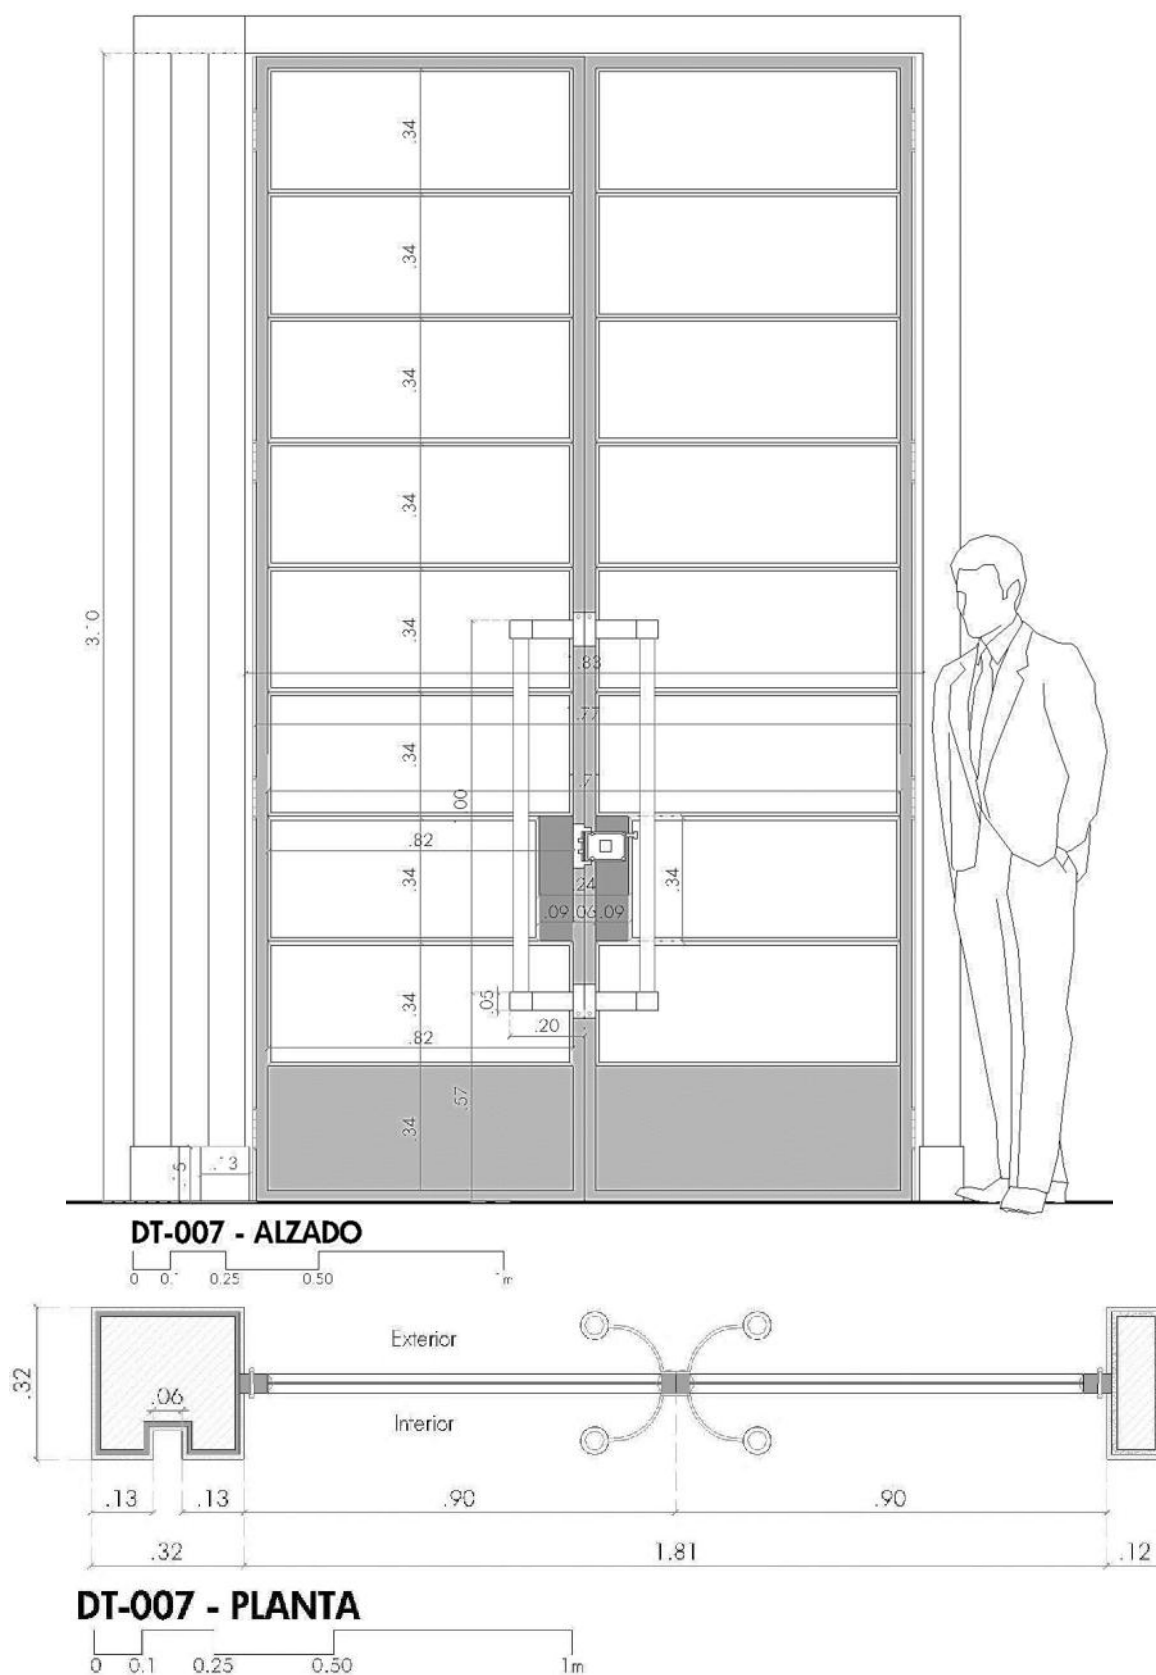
Alzado y planta de la puerta principal del acceso.
